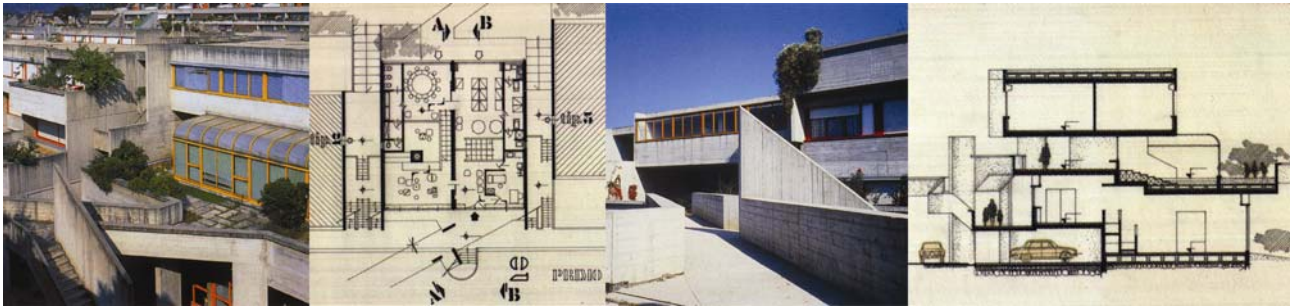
Immagini, pianta e sezione di uno degli edifici destinati a servizi.
